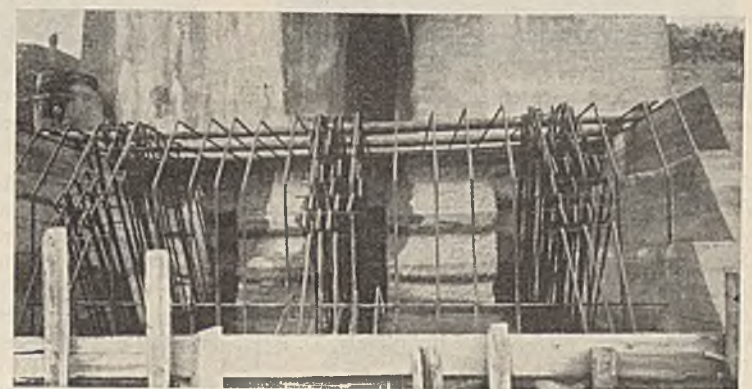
Bewehrung der Unterzüge und Verzahnung des Eisenbetonringkranzes.
